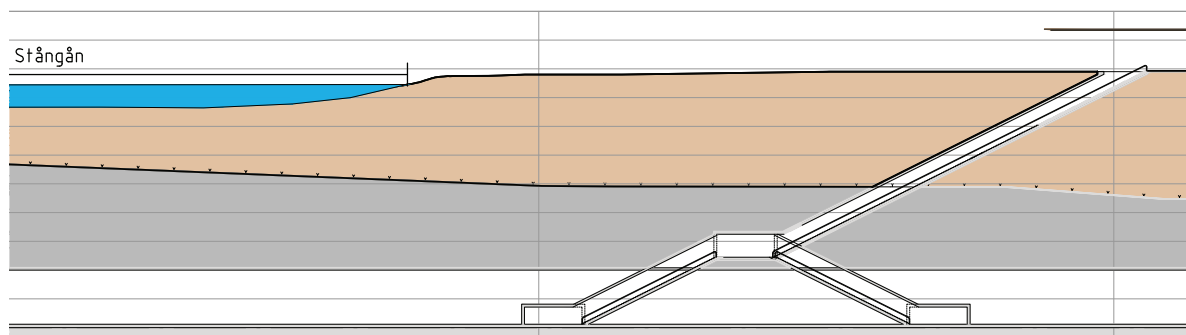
Exempel på principprofil under Stångån enligt korridorförslag C där både Ostlänken och Södra stambanan förläggs i tunnel.
